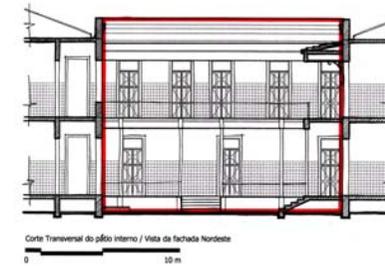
Estudo de proporção do pátio interno do CP11, corte transversal e vista da fachada Nordeste (Fonte: O AUTOR,2006).
